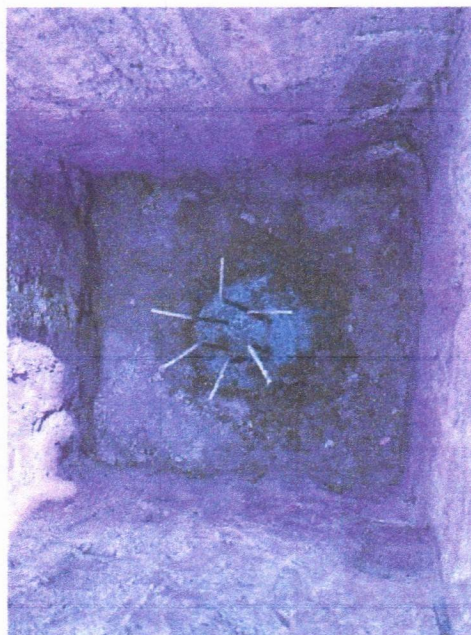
Execução da concretagem das fundações tipo estacas.
